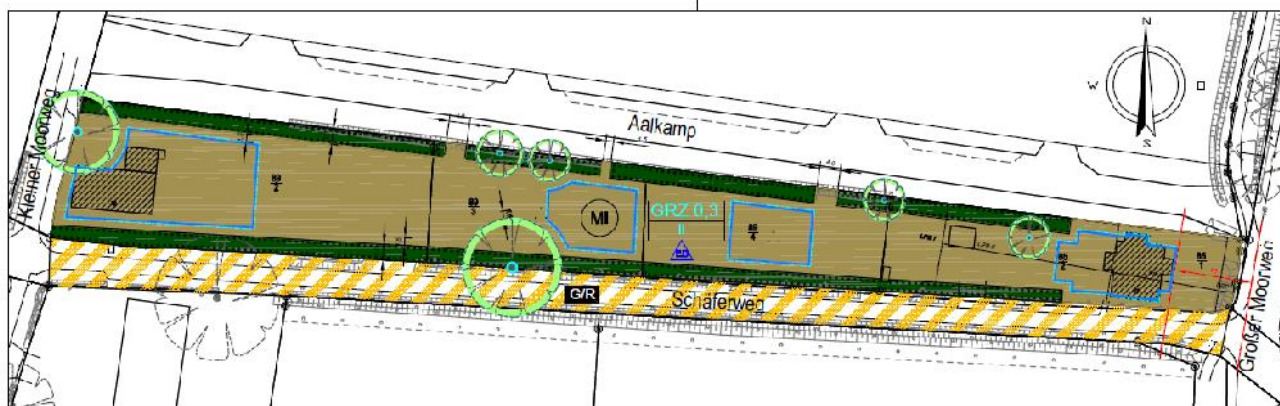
B-Planentwurf (Quelle: Stadt Tornesch, Stand 21.11.2017)
